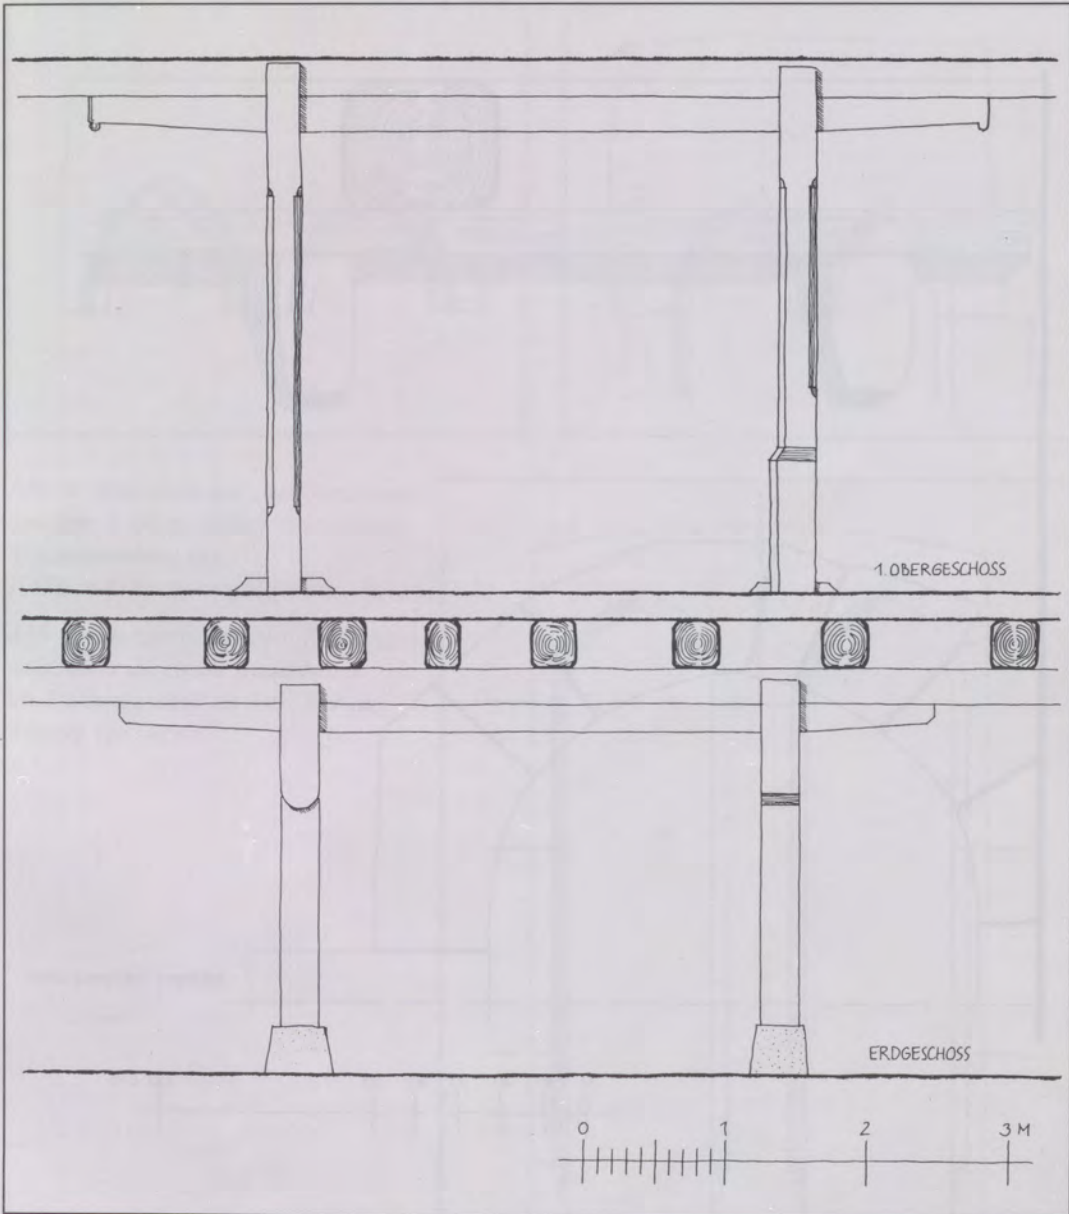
Stützenkonstruktion im Erdgeschoß und 1. Obergeschoß
